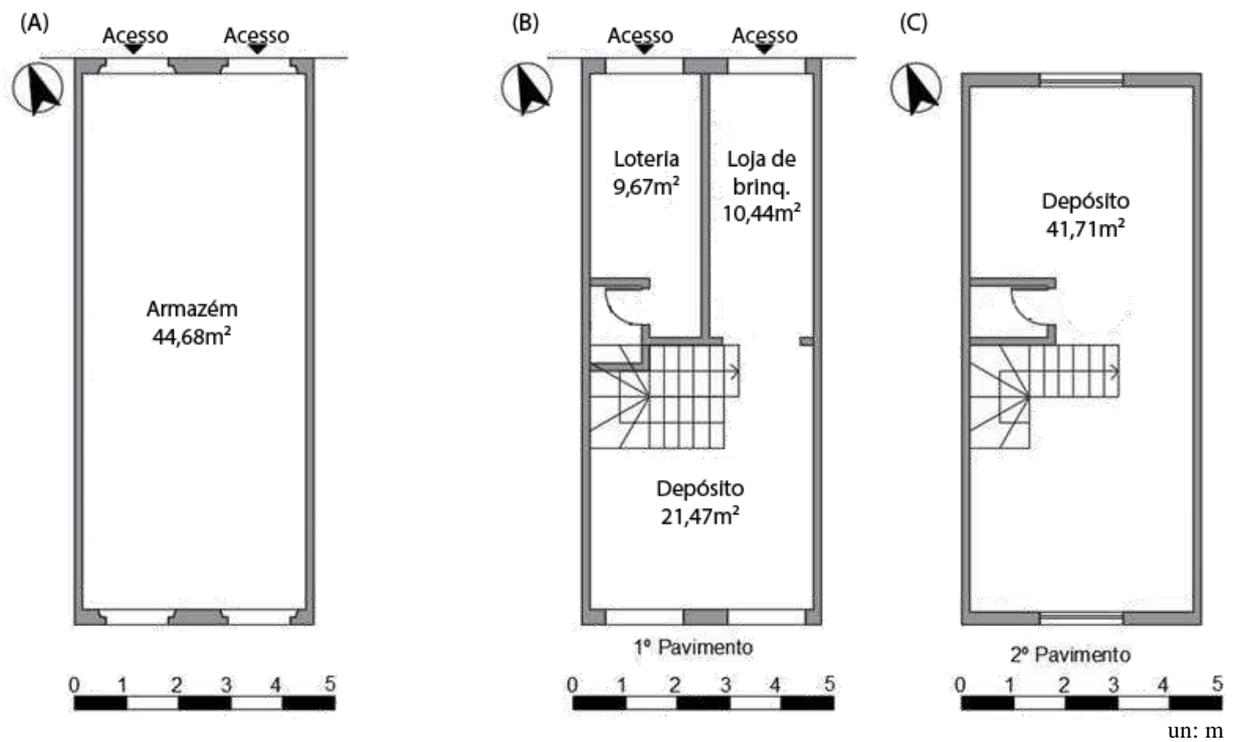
Projeto arquitetônico do edifício histórico (A) Planta baixa original; (B) Planta Baixa Modificada 1º Pavimento; (C) Planta baixa 2º Pavimento (Autores, 2018)
